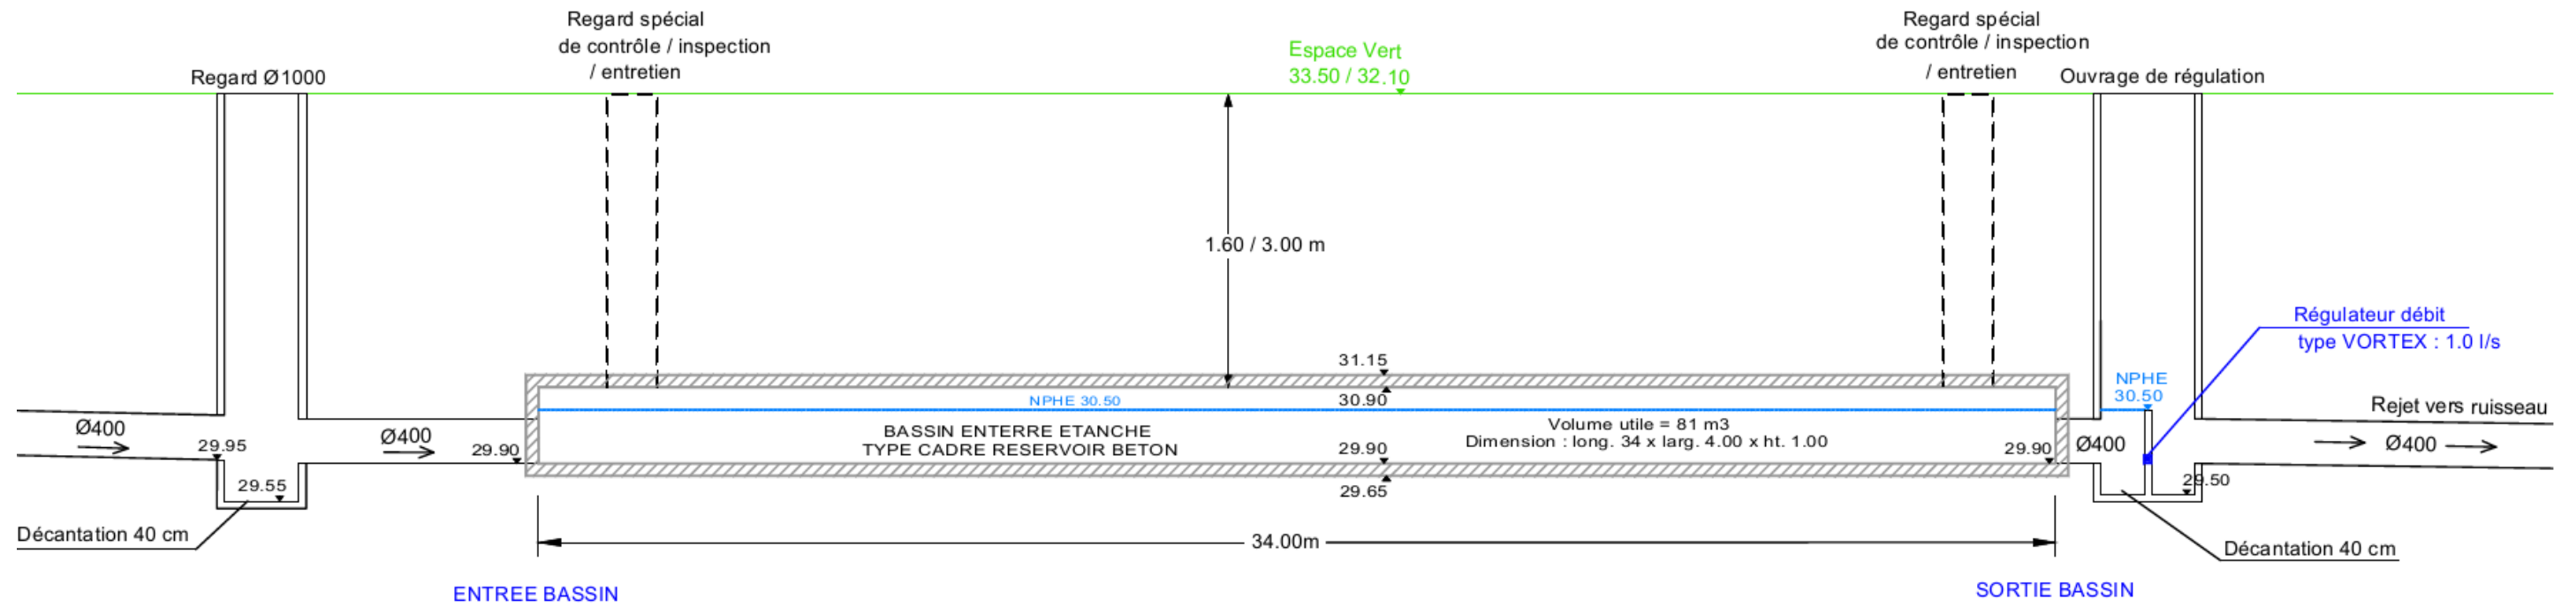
SCHEMA DE PRINCIPE DU BASSIN ENTERRE ETANCHE TYPE CADRE RESERVOIR BETON
